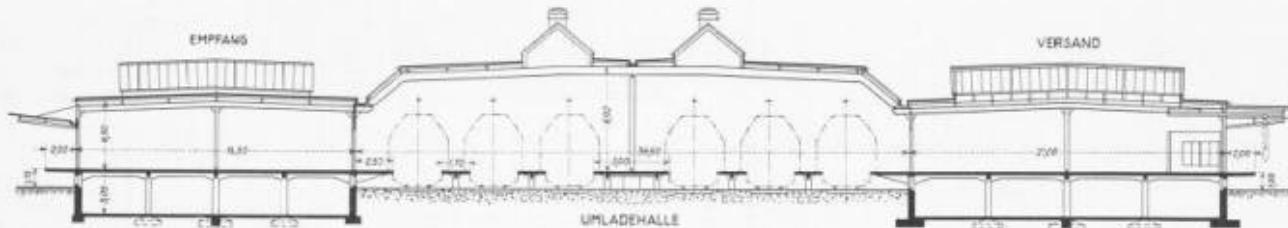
Querschnitt durch Empfangs-, Umlade- und Versandhalle samt Lagerräumen des SBB-Güterbahnhofs Bern-Weiermattshaus. — Masstab 1 : 450.
